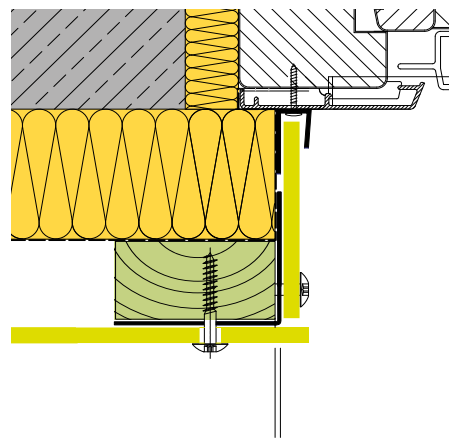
DETAILLERING: HOUTEN CONSTRUCTIE HORIZONTALE DOORSNEDE
